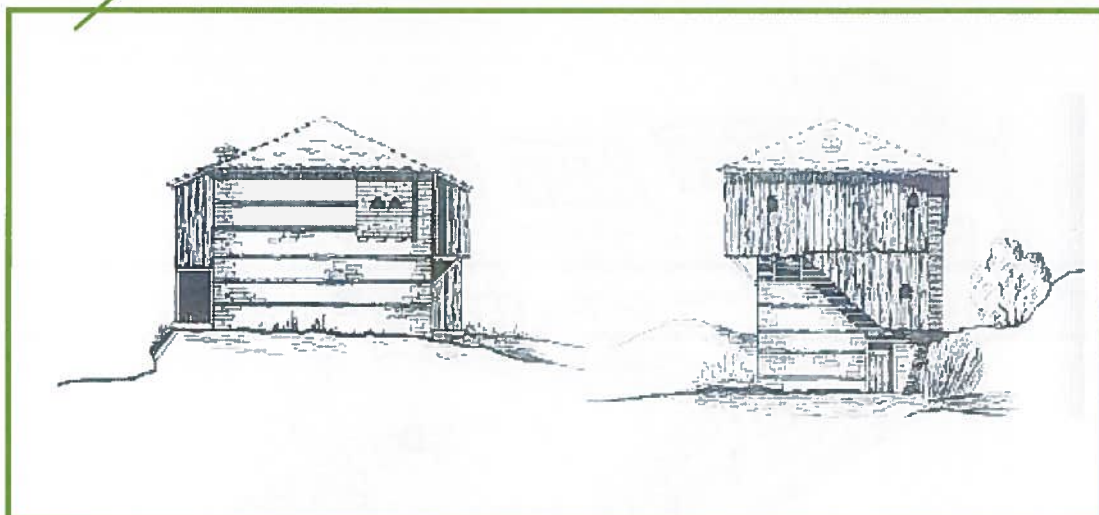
Ndërtesa kryesore : pamje tip, Stebleve shembull 2
